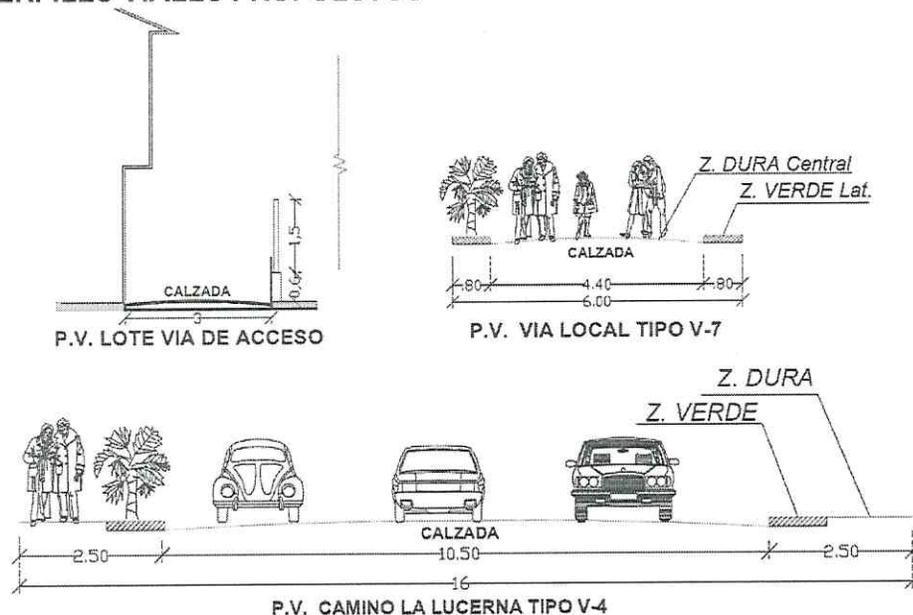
Perfil vial propuesto VIA LOCAL PUBLICA y VIAL LOTE DE ACCESO
